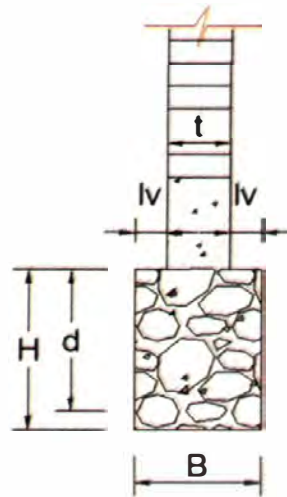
Sección de la cimentación – Caseta de Válvulas.
